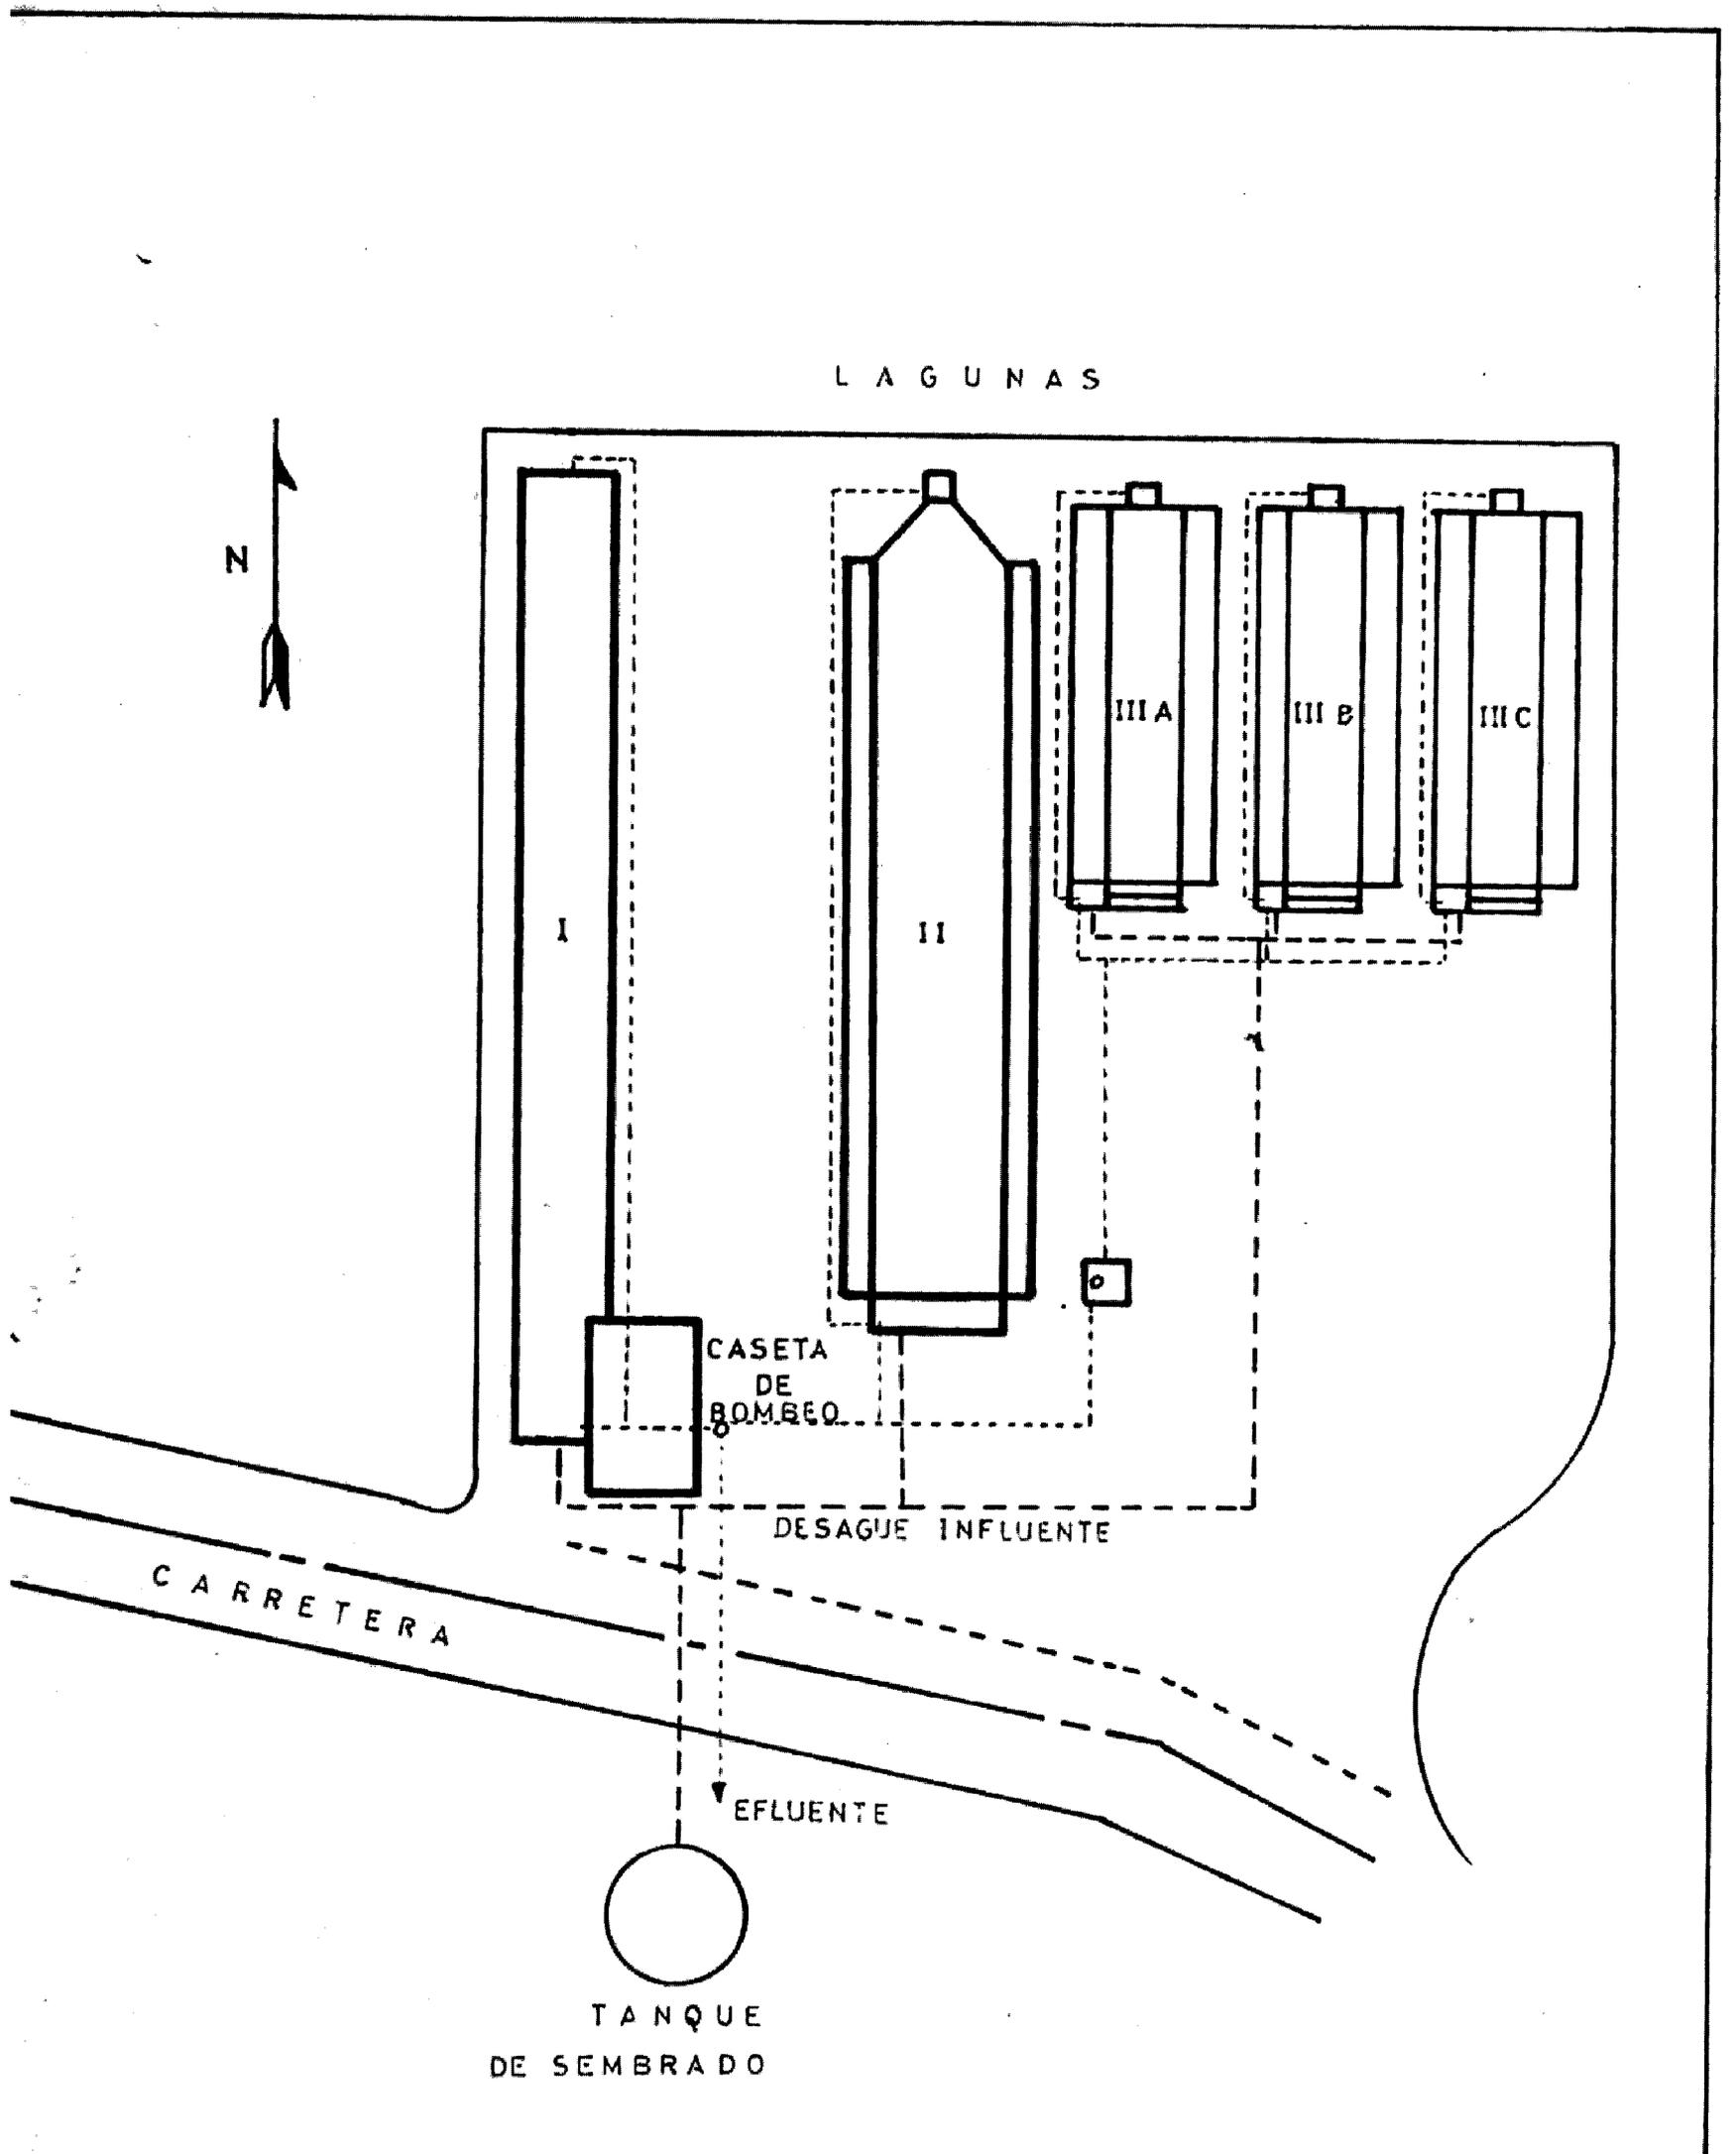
DISPOSICION DE UNA PLANTA PILOTO DE LAGUNA DE ESTABILIZACION EN RICHMOND - CALIFORNIA.
